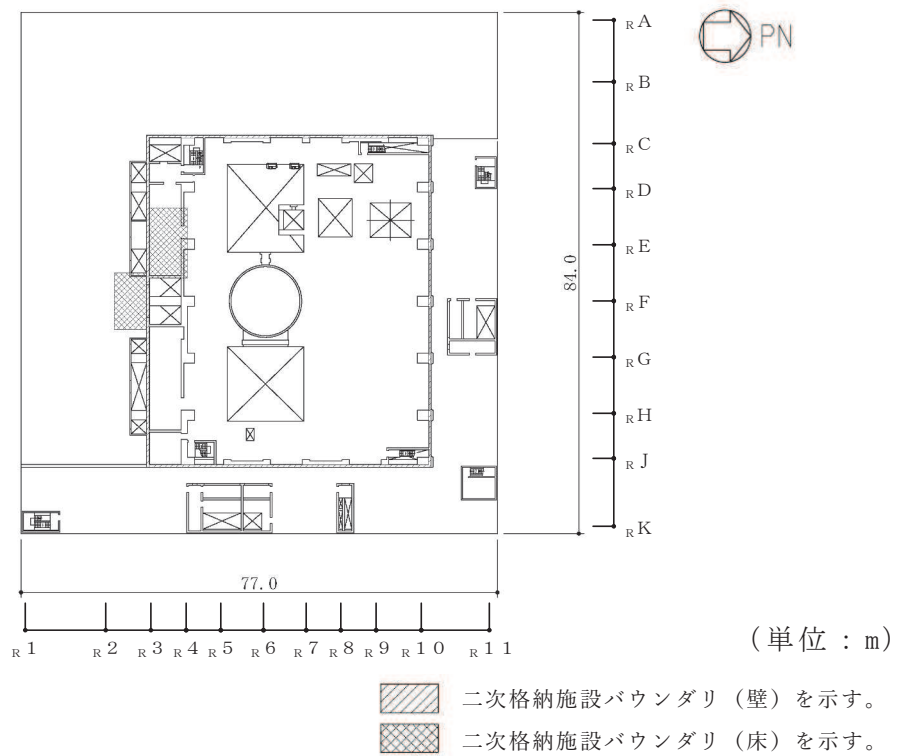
原子炉建屋原子炉棟（二次格納施設）の範囲の平面図
